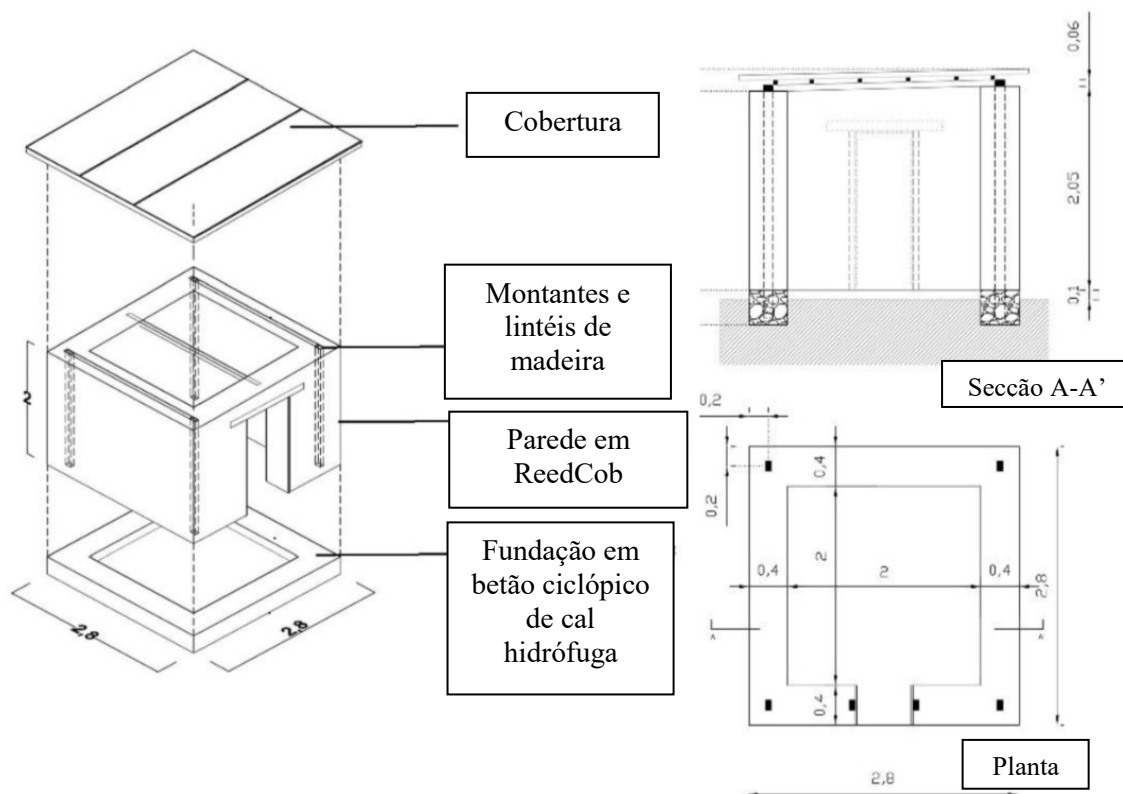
Vista 3D, planta e corte do projeto da célula ReedCob (adaptado de Carneiro et al., 2017).
